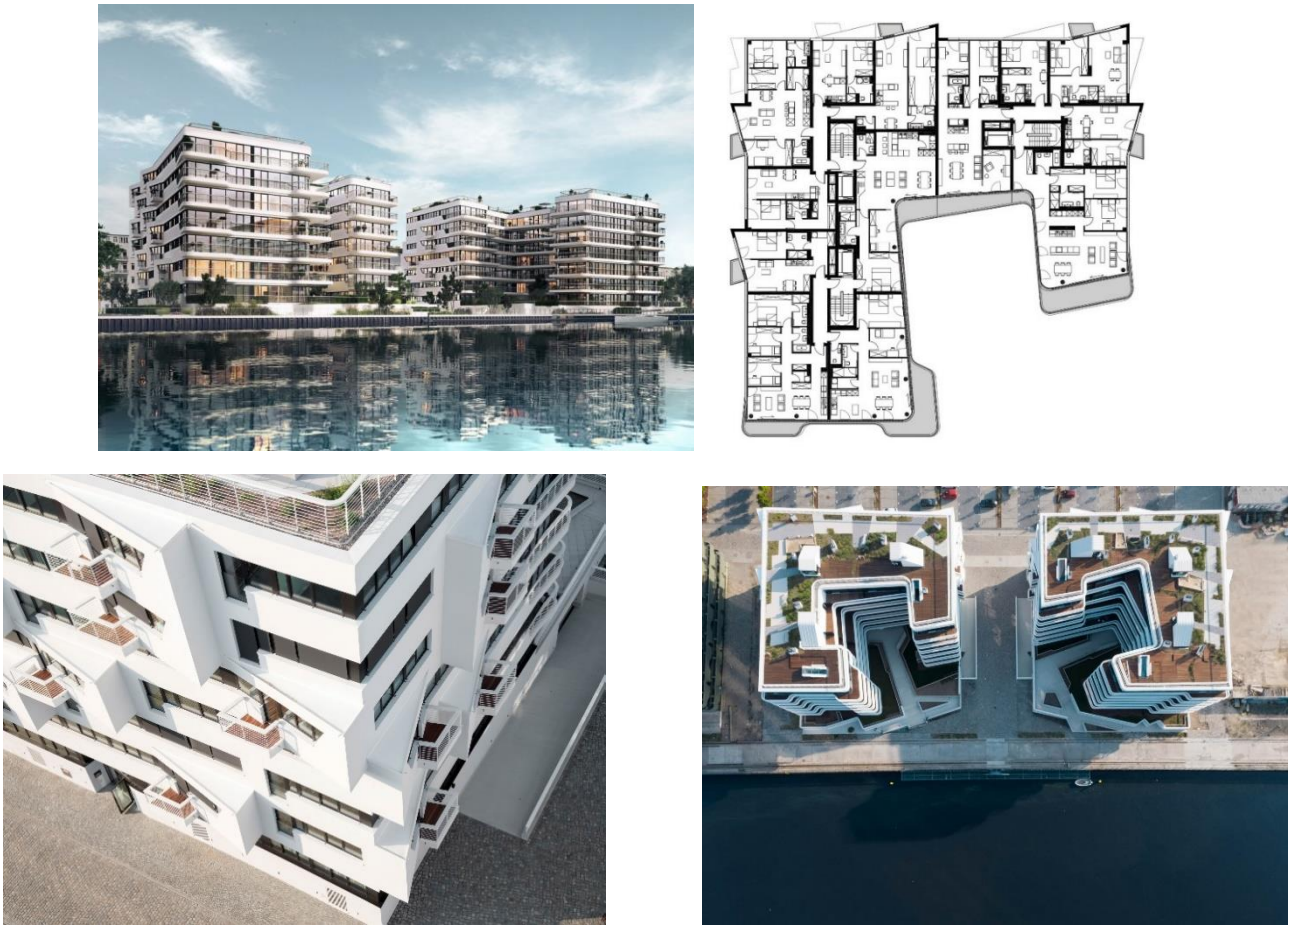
Проект ЖК Wave, Німеччина, Берлін.
